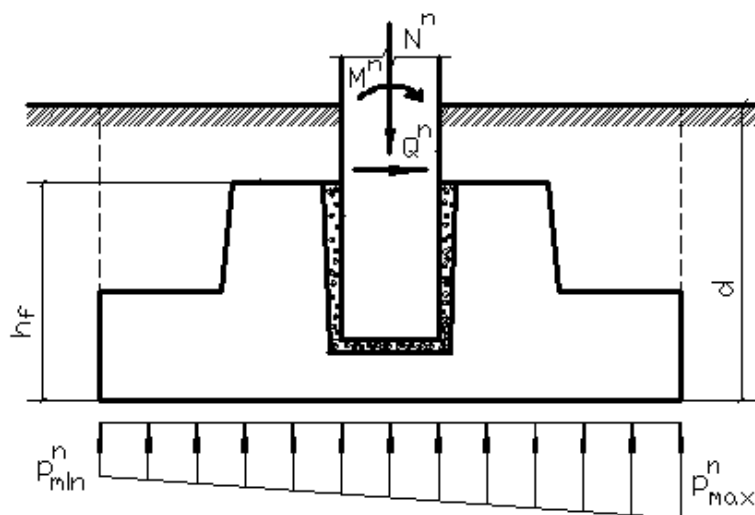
Расчетная схема для проверки размеров фундамента в плане
